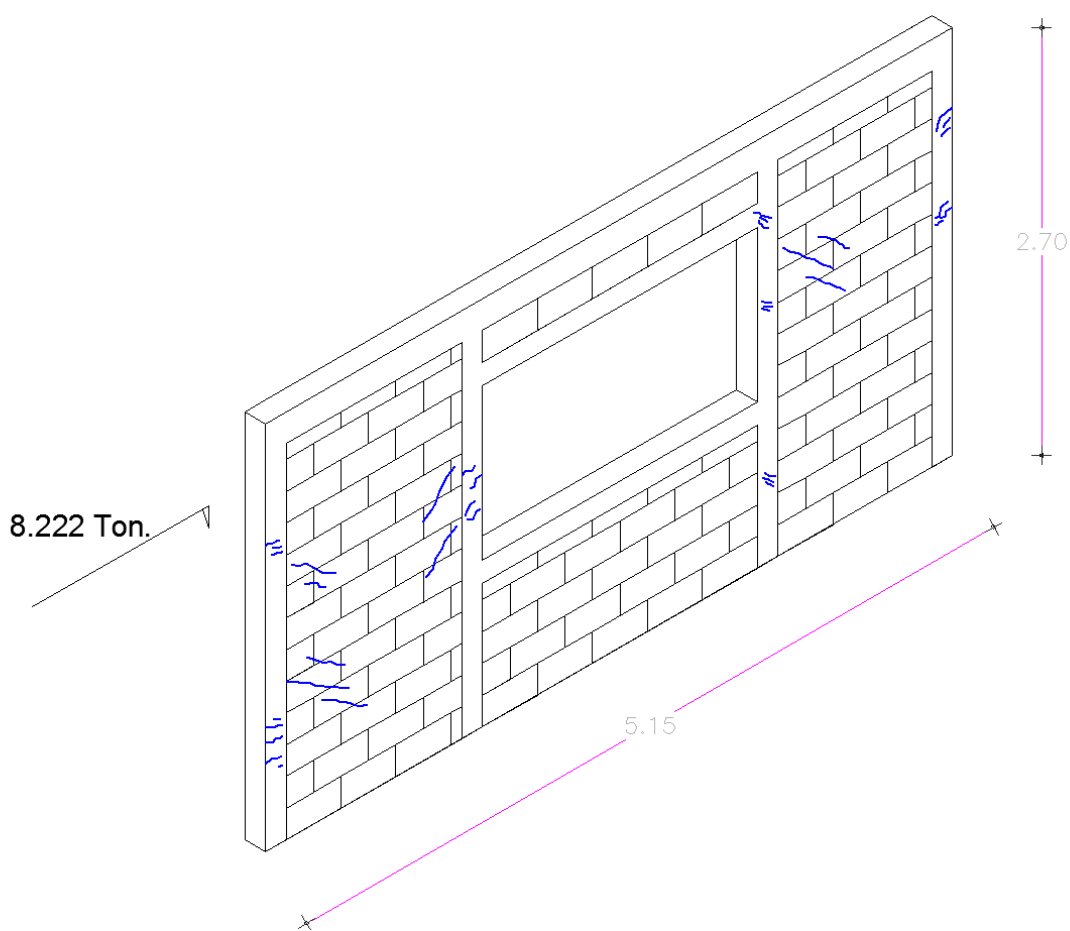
Carga Lateral y posible Estado de Daño del muro "O" Mampostería Confinada empleando Block hueco de concreto.
